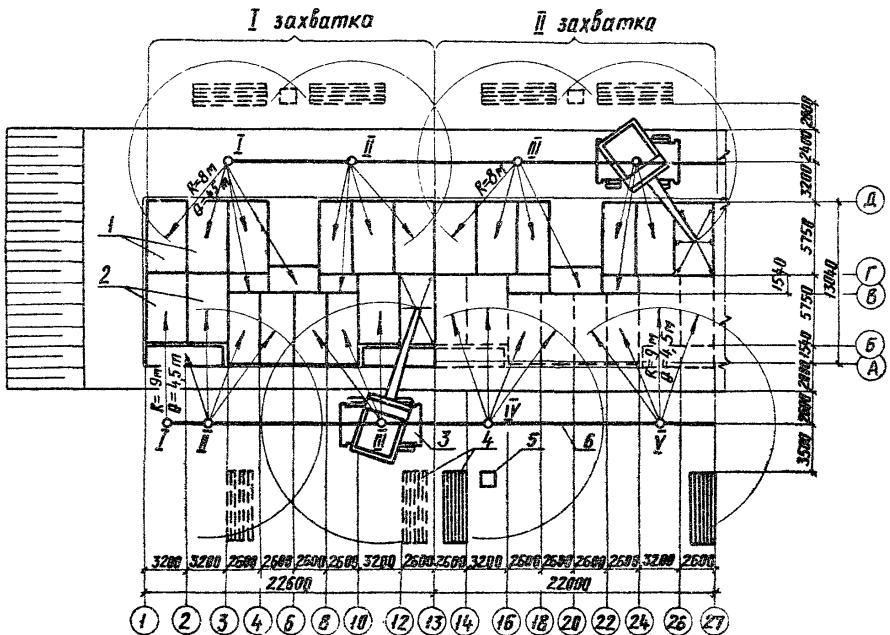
Схема организации работ по монтажу панелей перекрытия технического подполья: 1-панели смонтированные краем в 1; 2-панели смонтированные краем в 2; 3-пневмоколесный кран К-16; 4-панели в кассетах; 5-ящики для раствора; 6-ось движения крана; 1, II, III, IV-установки крана
